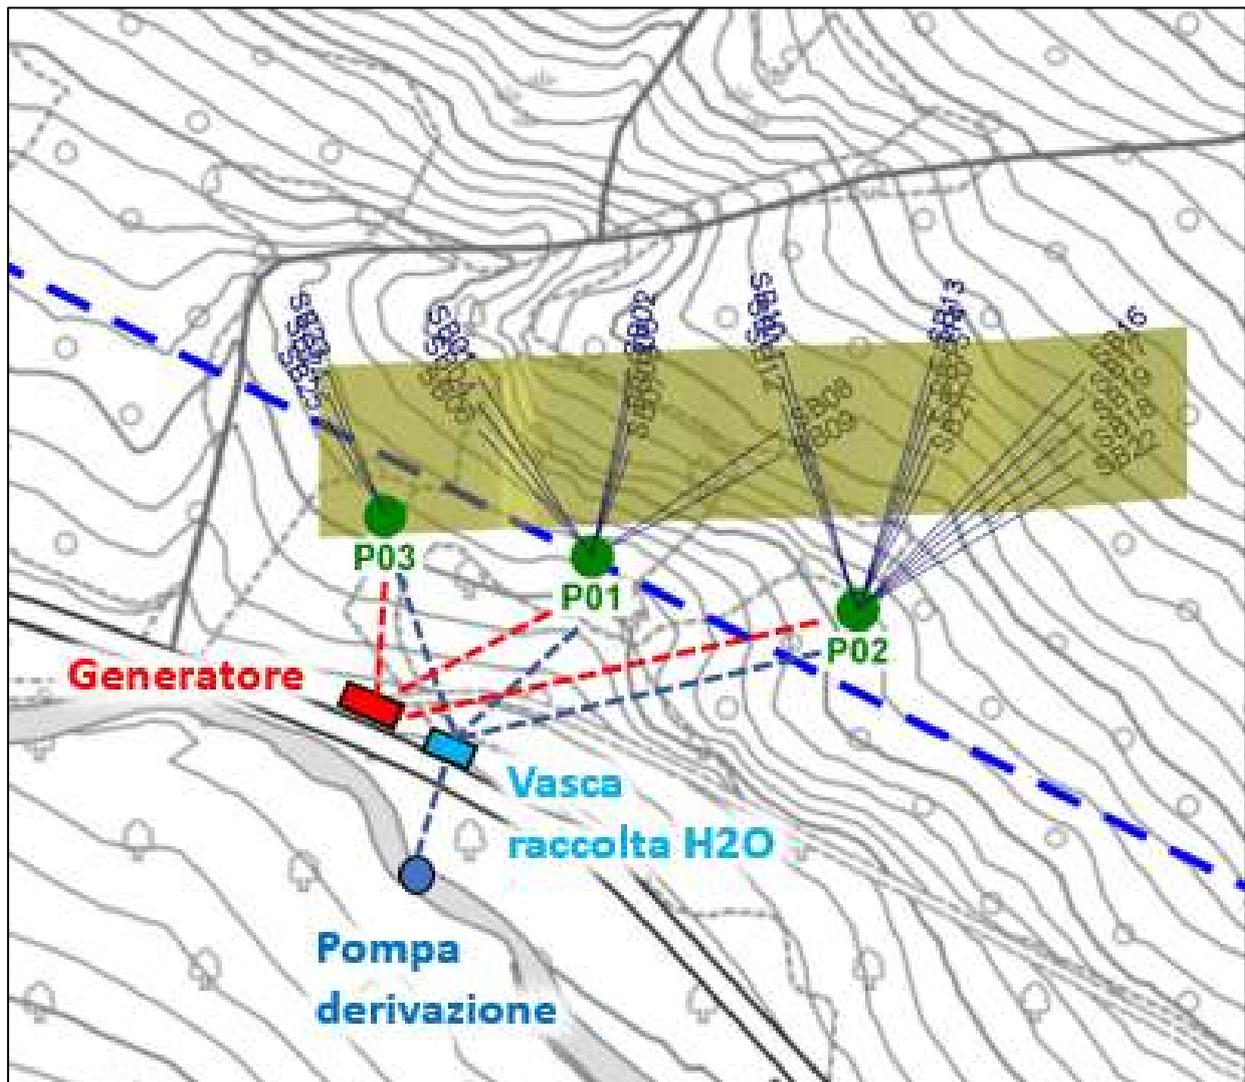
Individuazione piazzole di lavoro Area Santa Barbara
